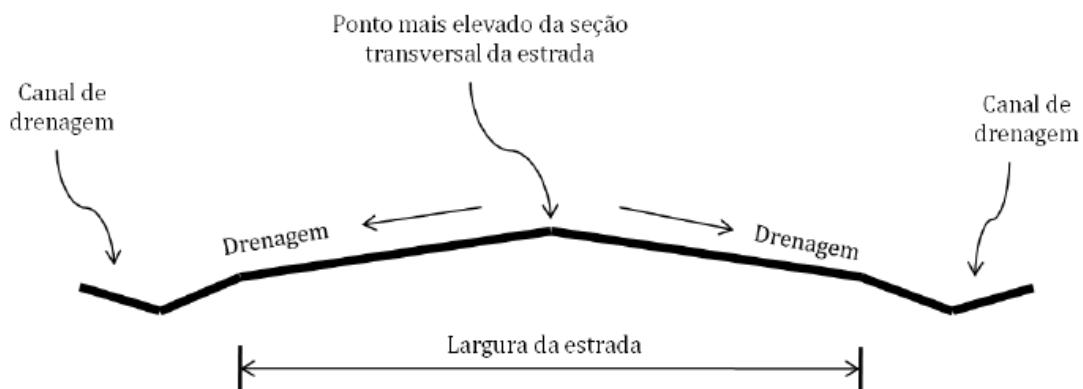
SEÇÃO TRANSVERSAL PISTA ABAULADA (RETAS)
